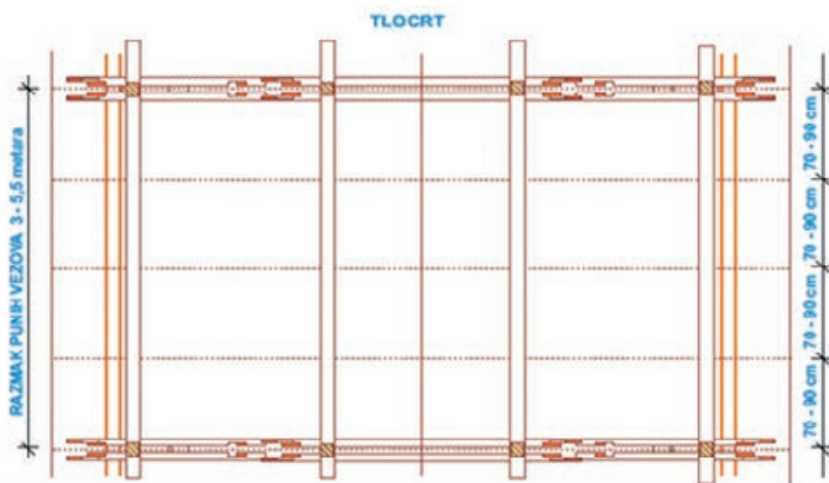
Elementi povezani u čvrstu drvenu konstrukciju [13]
